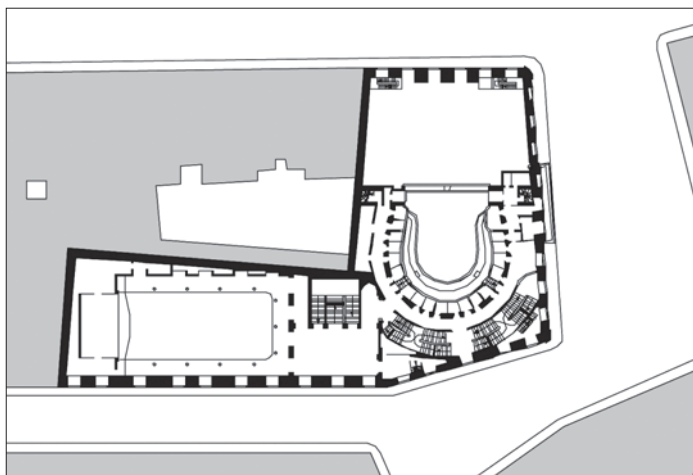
Planta do Piso da 1ª ordem de Camarotes do Teatro da Trindade.
